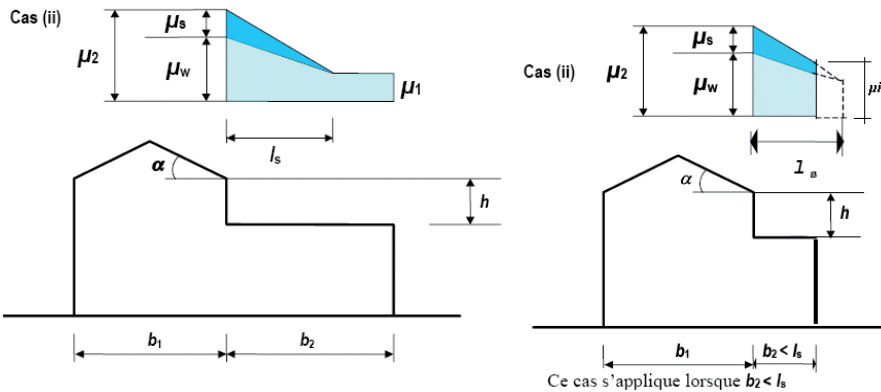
Dispositions de charge avec accumulation pour les toitures attenantes à une construction supérieures ou très proches d'elles.
